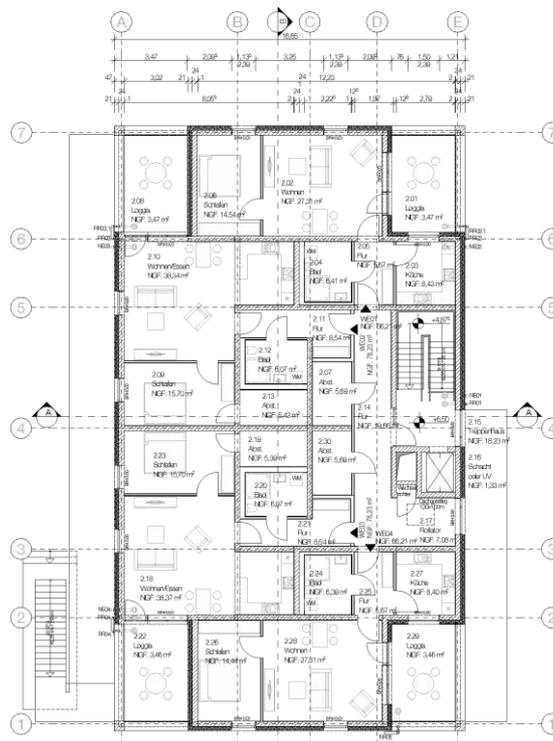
Grundriss 2. OG _ Wohnen_HWR
